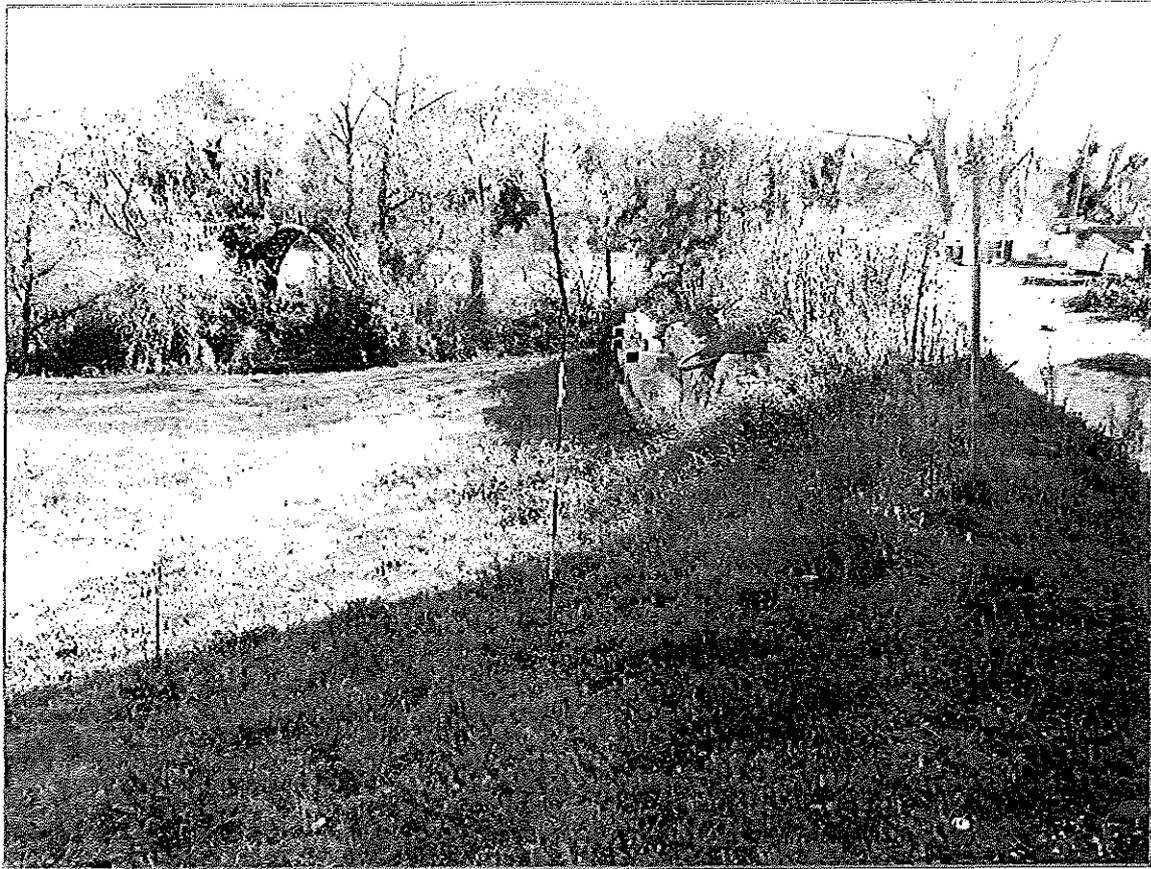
Lato Nord del lotto – Visto del muro a "secco" di sostegno scarpata
